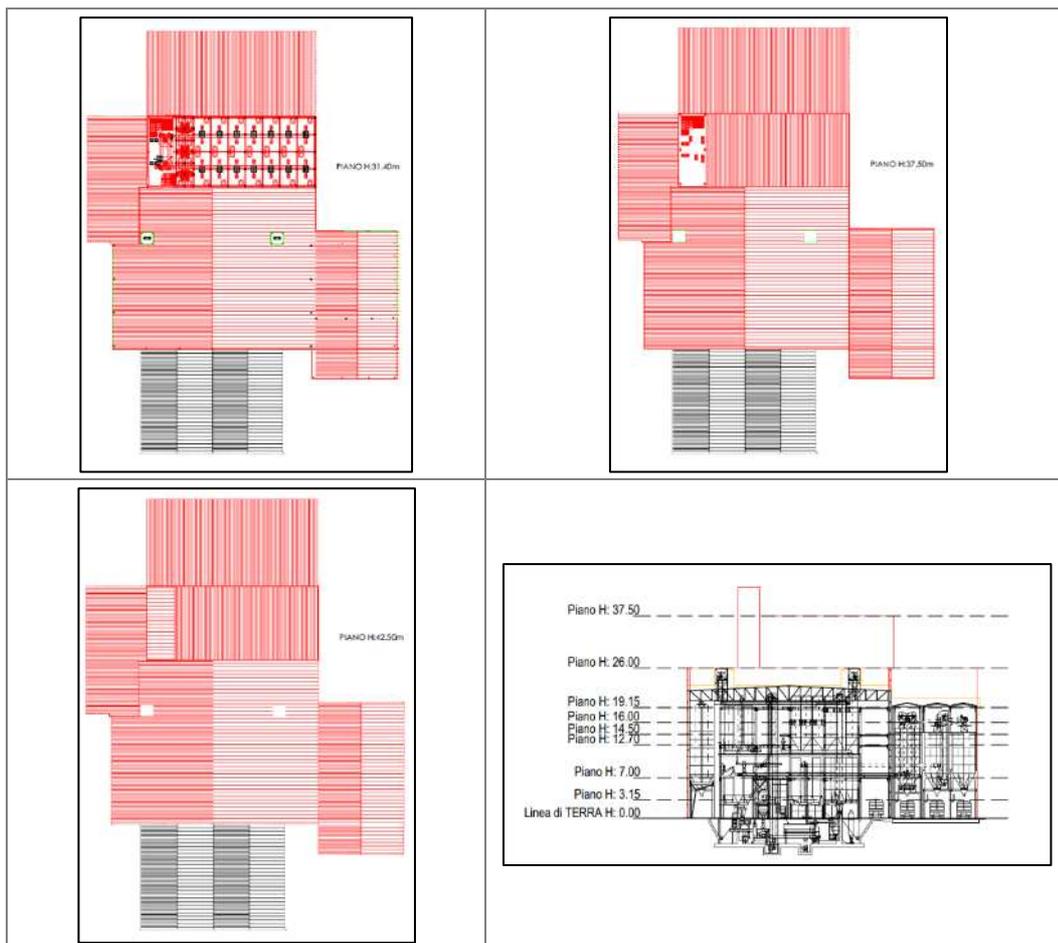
ESTRATTI PROGETTUALI LAYOUT INTERNO STRUTTURA PRODUTTIVA (SUDDIVISIONE PER PIANI)
